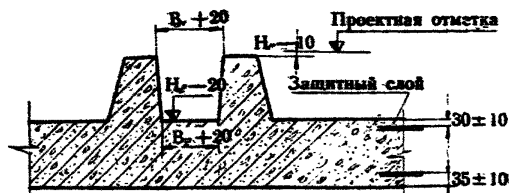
Допускаемые отклонения геометрических размеров фундаментной плиты и подколонников; B_1 - размер стакана подколонника в плане по верху; B_2 - размер стакана подколонника в плане по низу; H_1 - проектная отметка верха подколонника; H_2 - проектная отметка дна стакана
